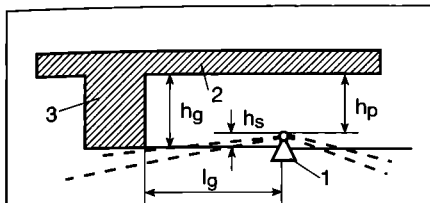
Distanțele de amplasare ale sprinklerelor față de planșee și grinzi:
